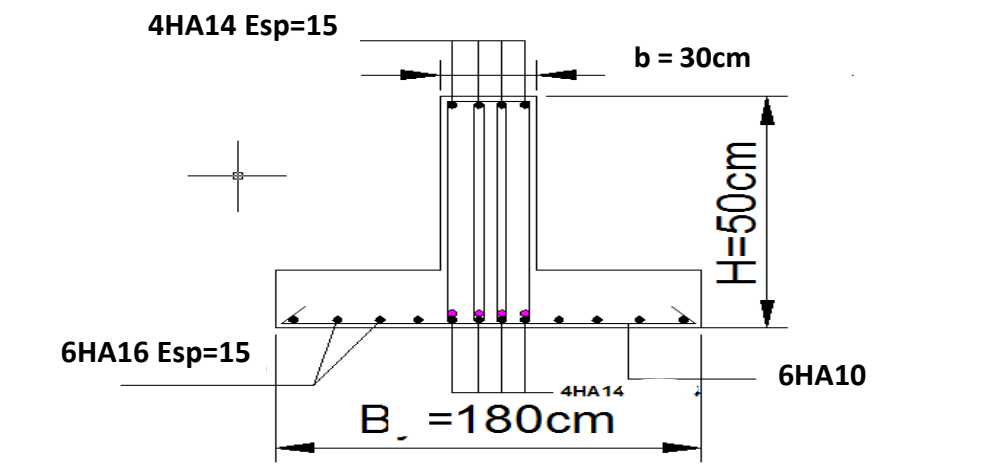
Ferrailage de la semelle filante sous 2 poteaux
